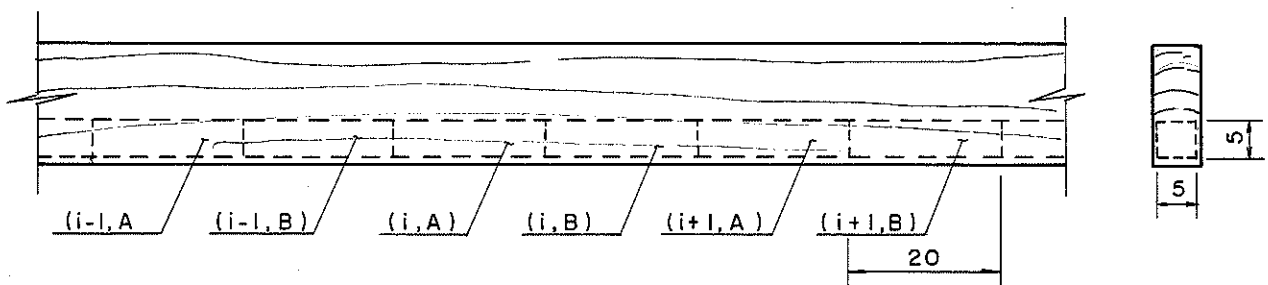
Obtenção de pares de corpos de prova sequenciais a partir de vigas aplainadas e sua numeração (dimensões em cm).
